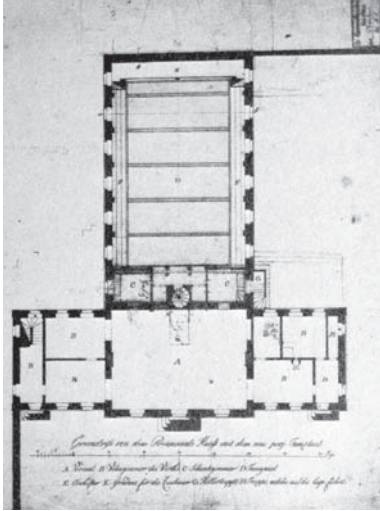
Baden-Baden: Promenadehaus, Grundriss für die Erweiterung durch Friedrich Weinbrenner mit einem rückwärtigen Tanzsaal, 1802 (GLA Karlsruhe Baupläne G Baden-Baden 61)
